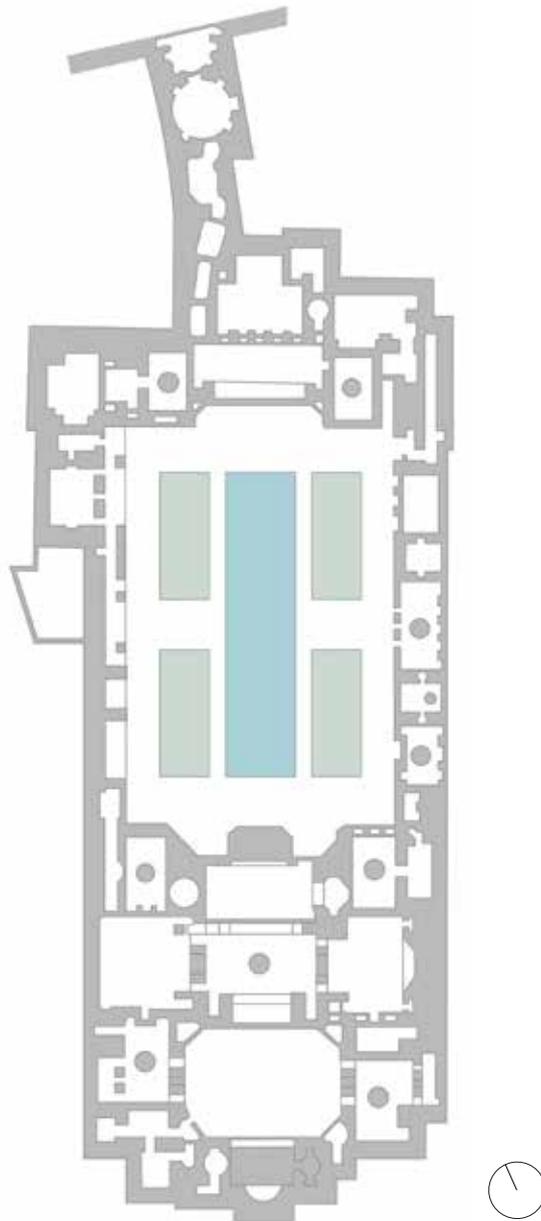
Grundriss des Borudscherdi-Hauses (eigene Bearbeitung).
